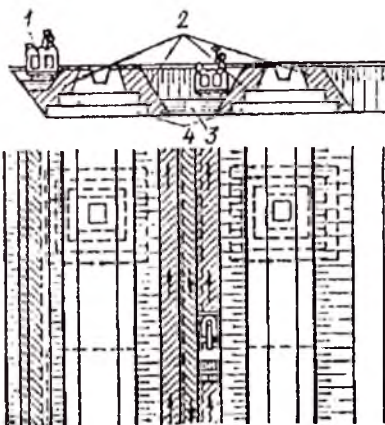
Уплотнение грунта в стесненных условиях:
